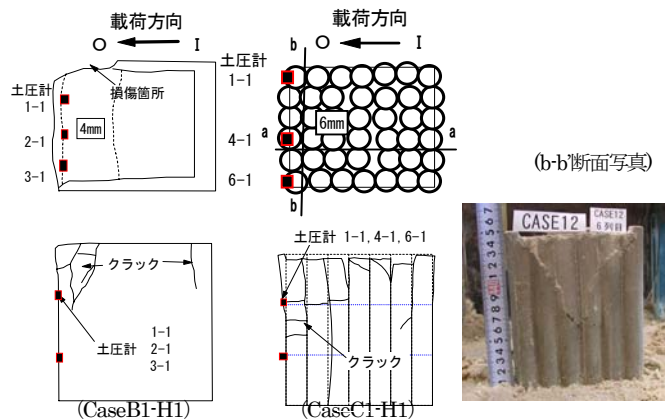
固化体の損傷状況 (上: 平面図, 下: 側面・断面図)
